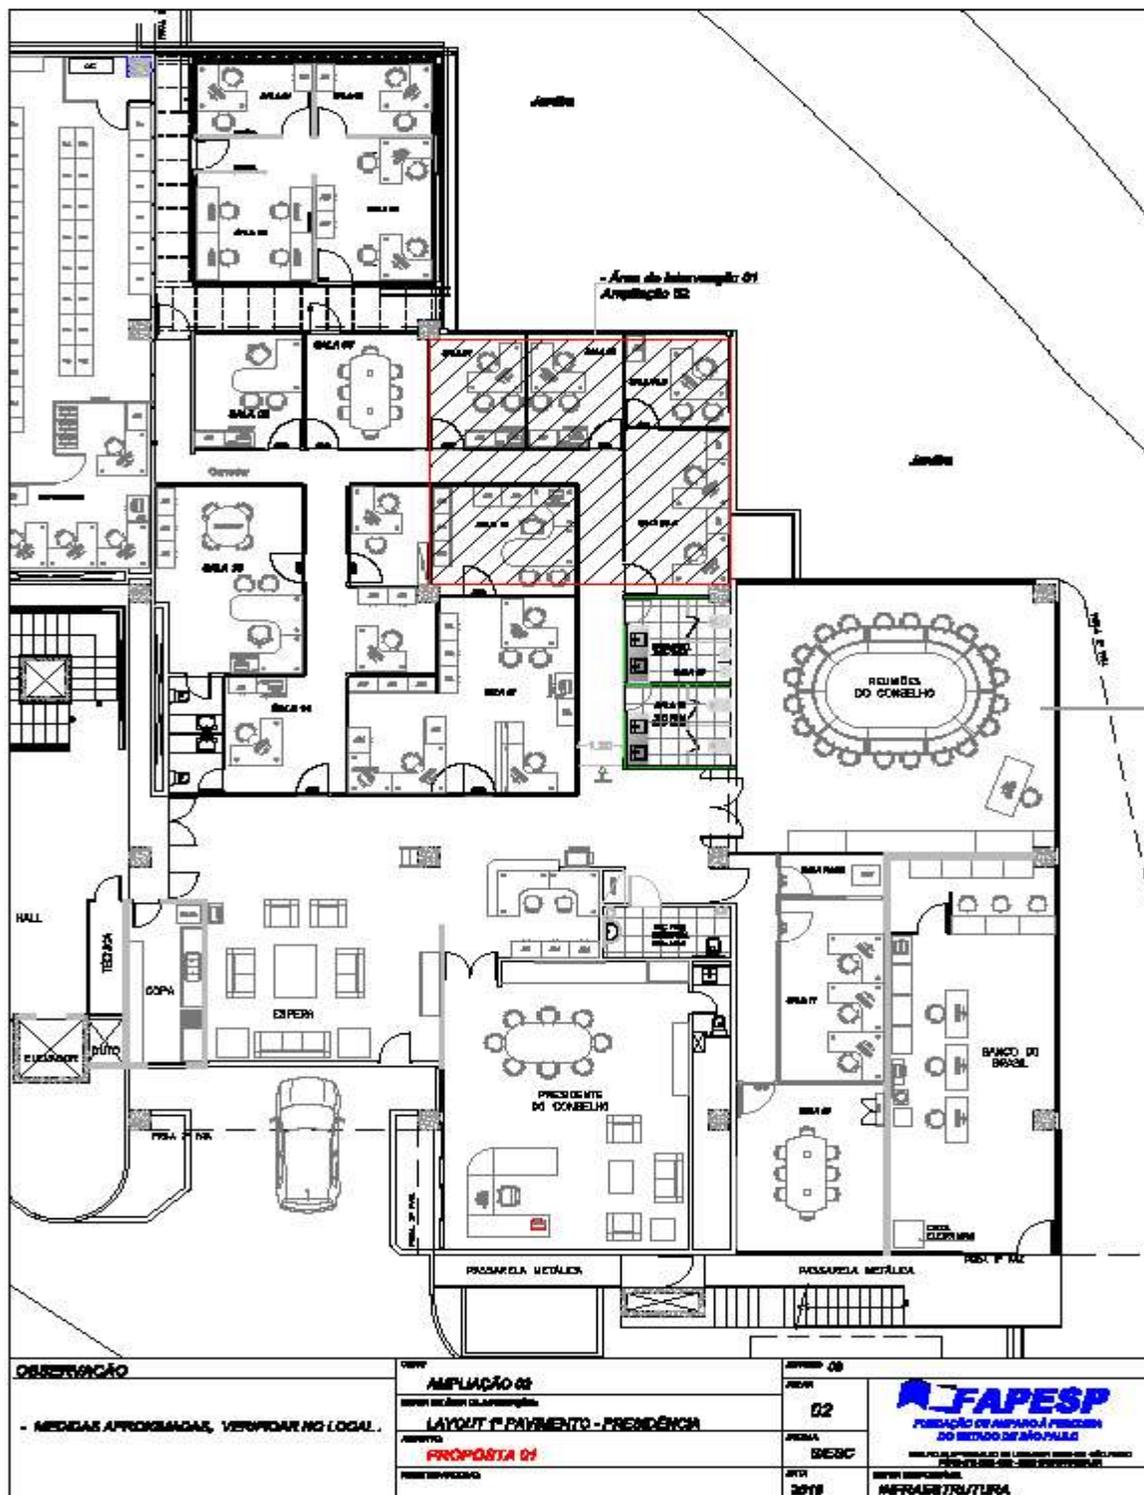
Planta Proposta 01 - Setor Presidência – 1º Pav.
